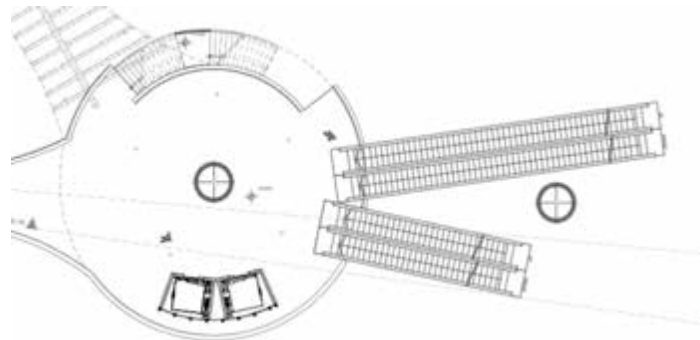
Plaza de acceso 2, planta 1 (+5.45m). (2017)
